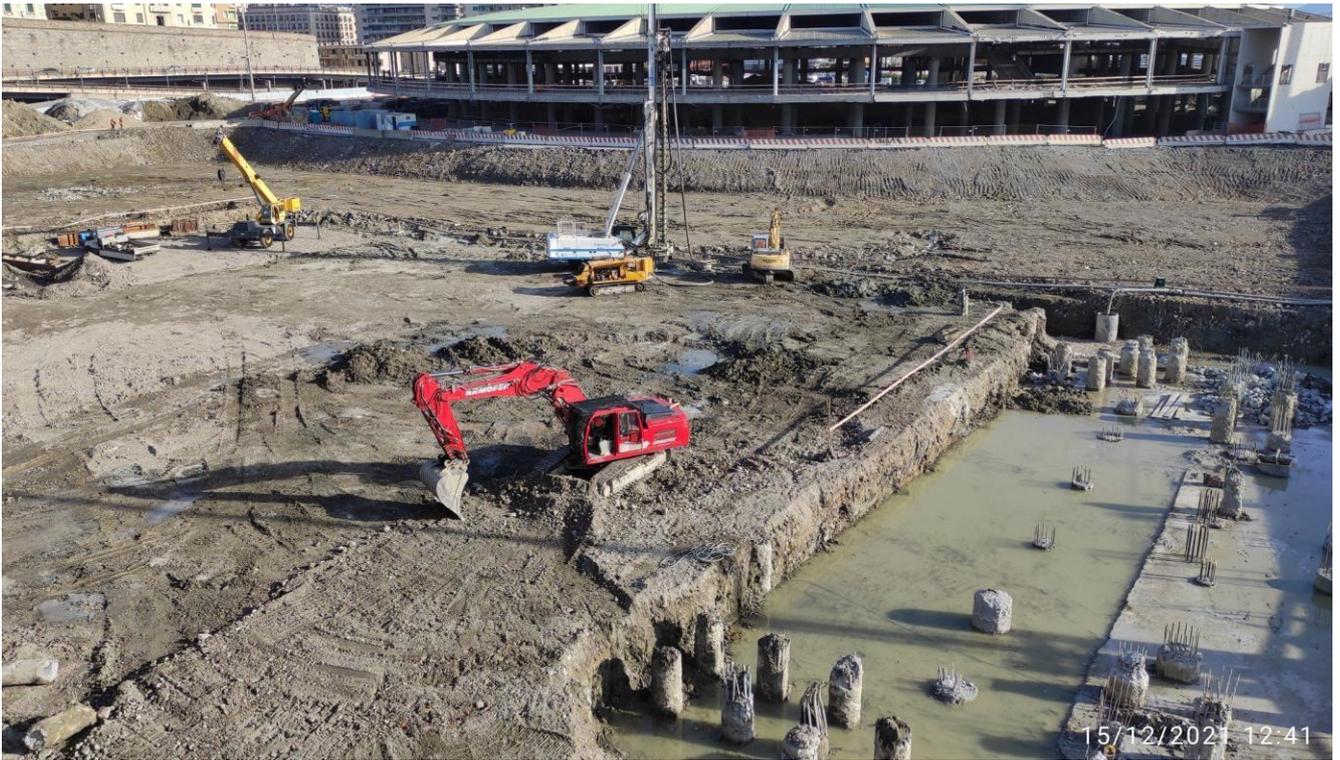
Cantiere Lotto 2.3 con avanzamento pali di fondazione a perimetro interferenti con tiranti paratia Canaletto
